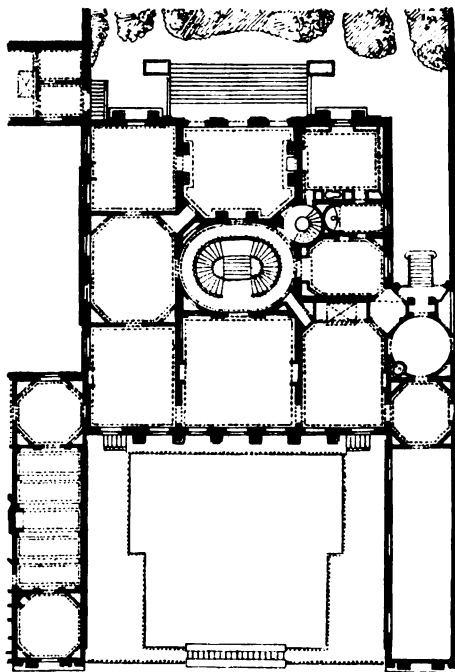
Grundriss des Hauses St. Foix et Carenne in Paris (n. Krafft u. Ransonette).
